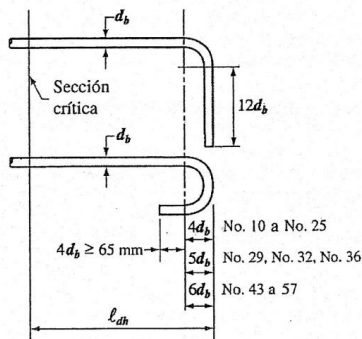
Detalles de barras dobladas para desarrollar el gancho estándar (American Concrete Institute)
